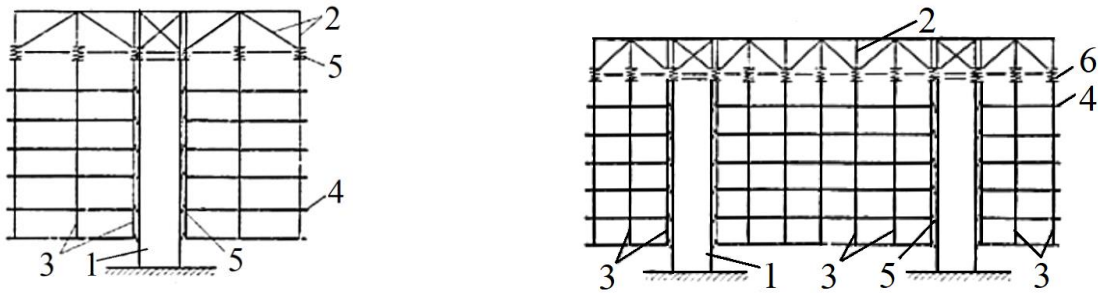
Подвесное здание: 1 – железобетонный ствол; 2 – двухконсольные фермы; 3 – подвески; 4 – подвесные перекрытия; 5, 6 – амортизаторы
